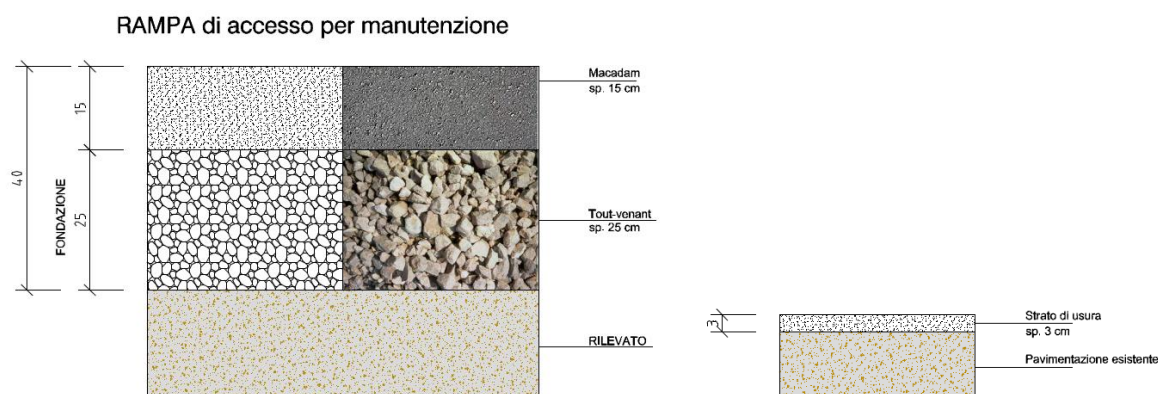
Sezione tipo rampa di servizio e pista ciclopeditonale
